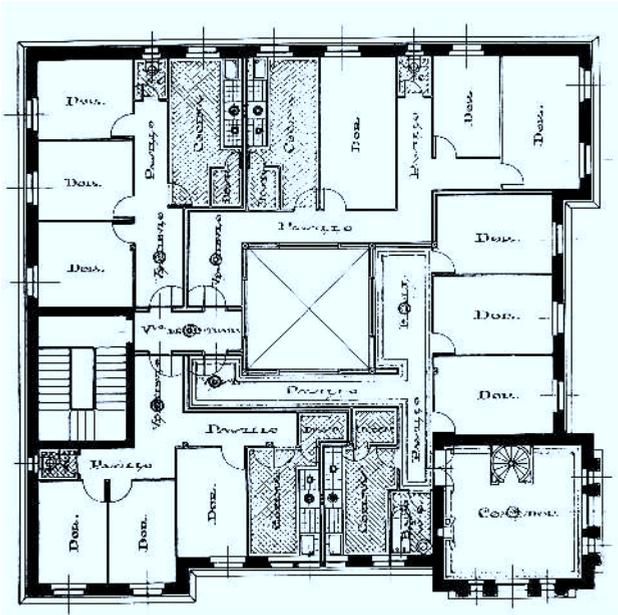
Proyecto para el Ayuntamiento de Carranza realizado en 1924 por el arquitecto Julio Sáenz de Barés. Planta del segundo piso. (Edificio no construido).
